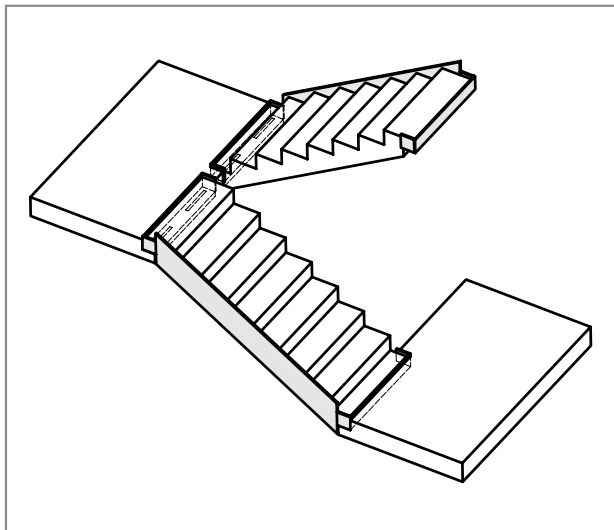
Rappresentazione secondo EN ISO 12354-2 di una rampa separata dal pianerottolo e dal solaio
